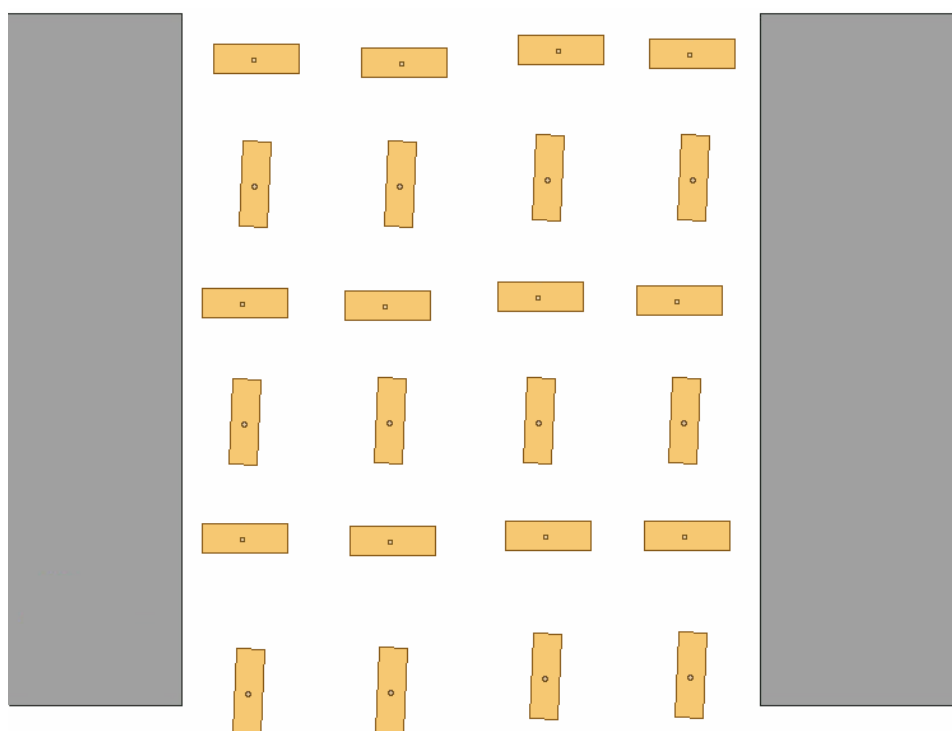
Disposição dos parafusos de teto da Mina Barro Branco.
